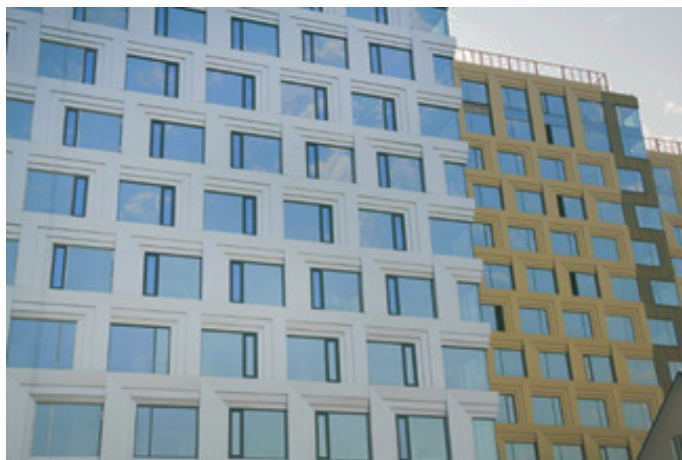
Вентилируемый навесной фасад здания из АКП [9]
